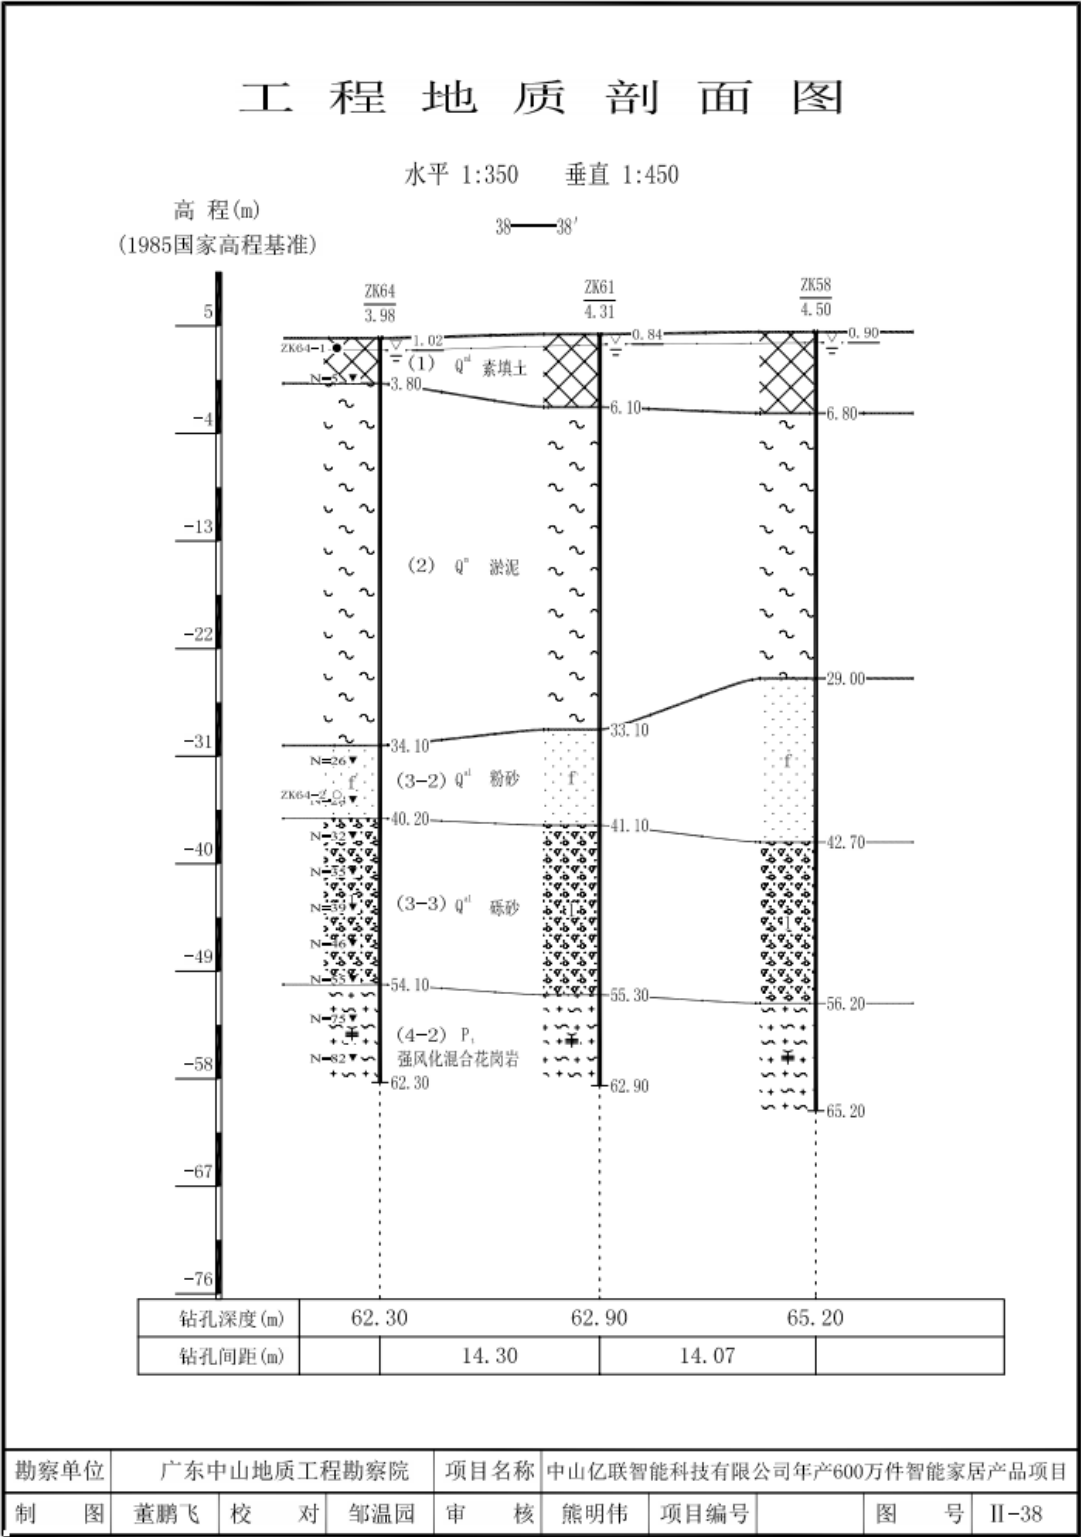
岩土勘察工程地质剖面图（38-38'剖面）
